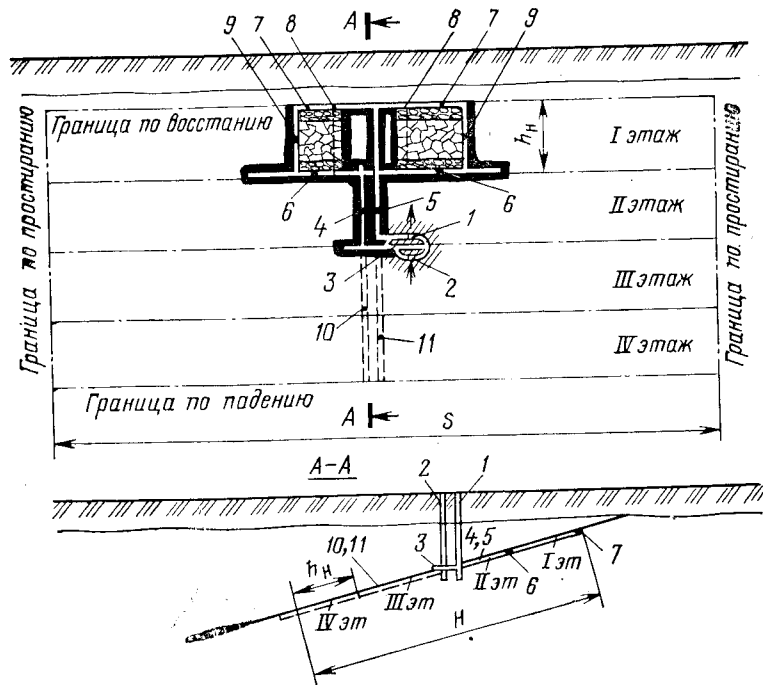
Схема вскрытия и этажная подготовка шахтного поля
